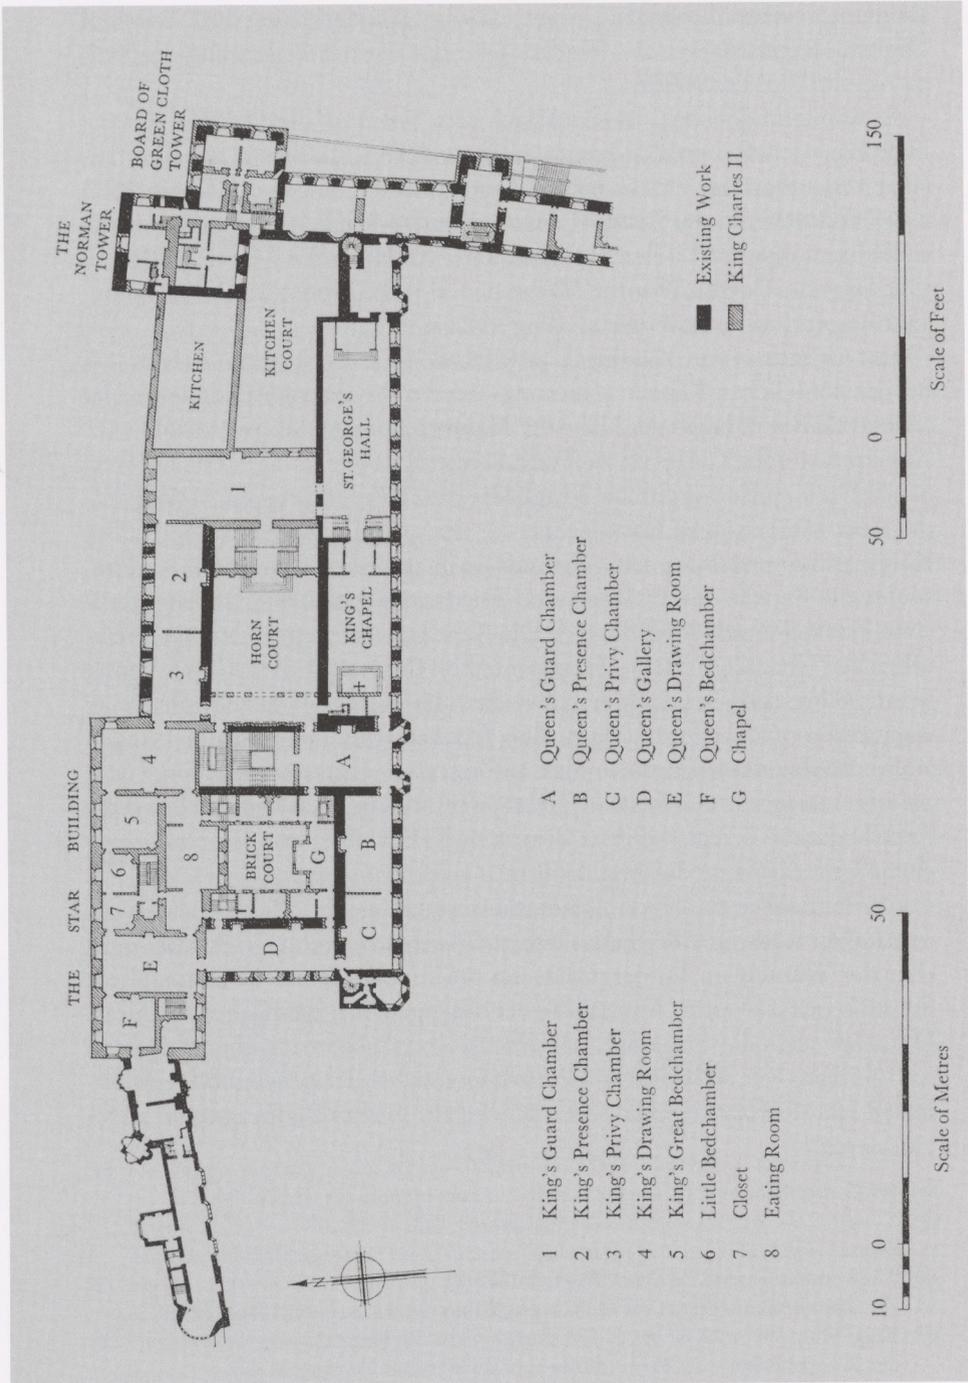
Windsor Castle, erstes Obergeschoss, Grundriss
